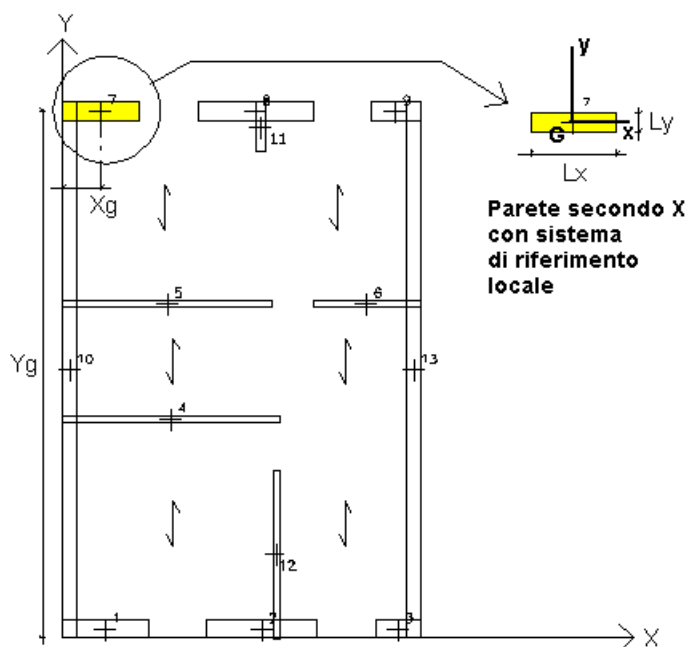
Esempio di pianta architettonica del piano di un edificio.
